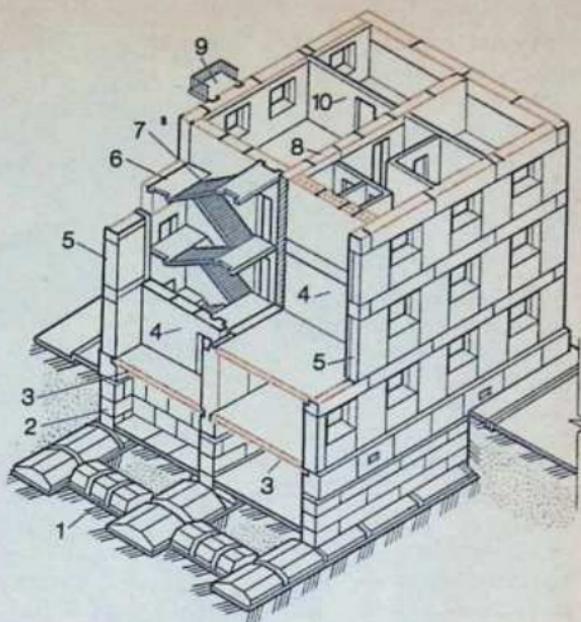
Конструктивная схема крупноблочного здания с продольными несущими стенами:
